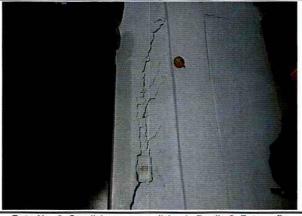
Condiciones muro divisorio Predio 2. Fotografía tomada el 17/04/2018
